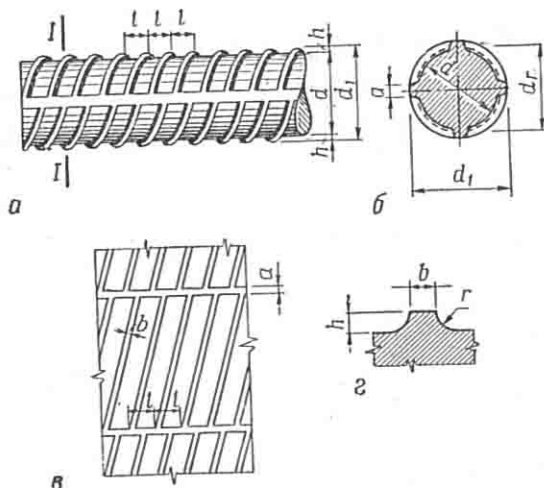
Стальной стержень периодического профиля: а — общий вид стержня; б — сечение по I—I; в — развернутая поверхность стержня; г — деталь винтового выступа
